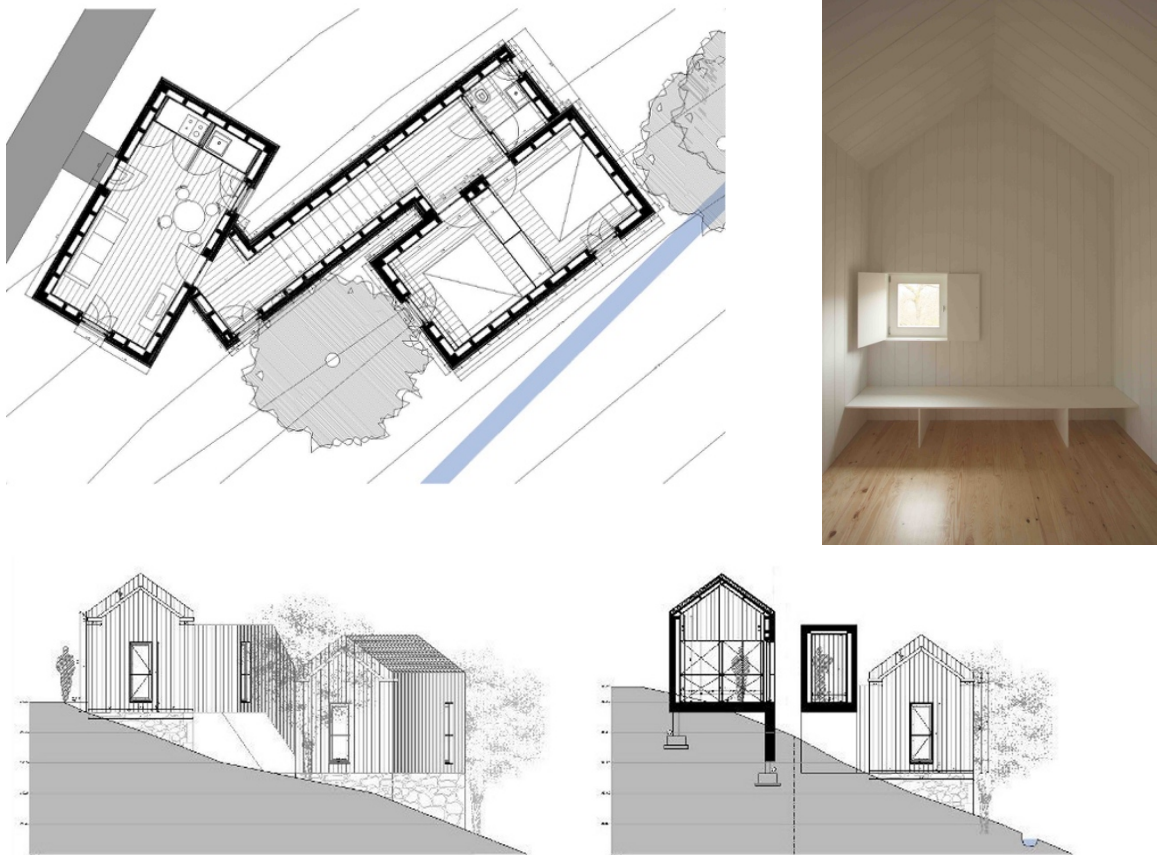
Planta, corte, fotografias de interior - Turismo Rural Montalegre.
